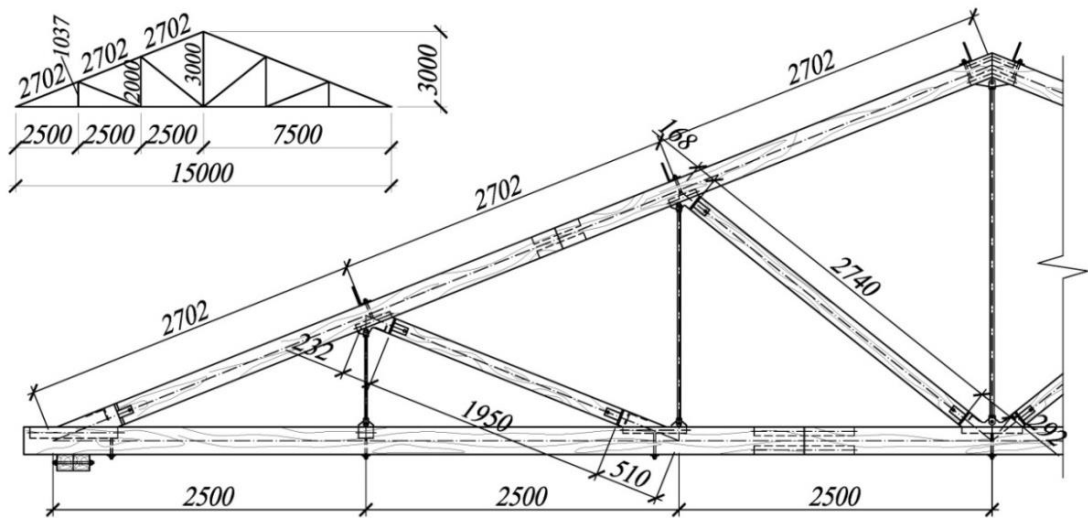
Ферма 2-го варианта с узлами на стальных плоских стержнях
